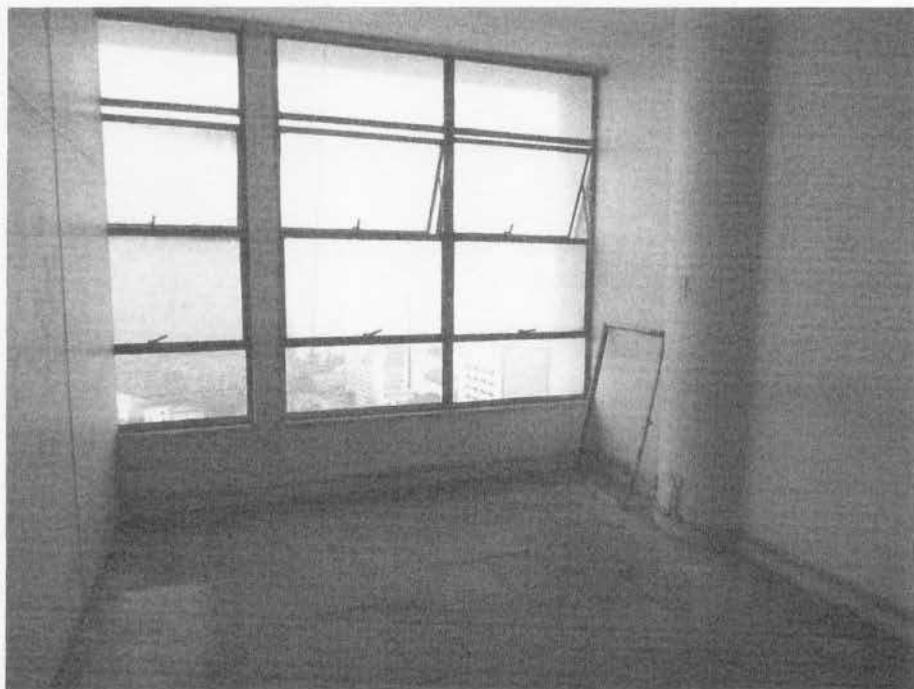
Vista da sala 3 do conjunto comercial 2.440.
